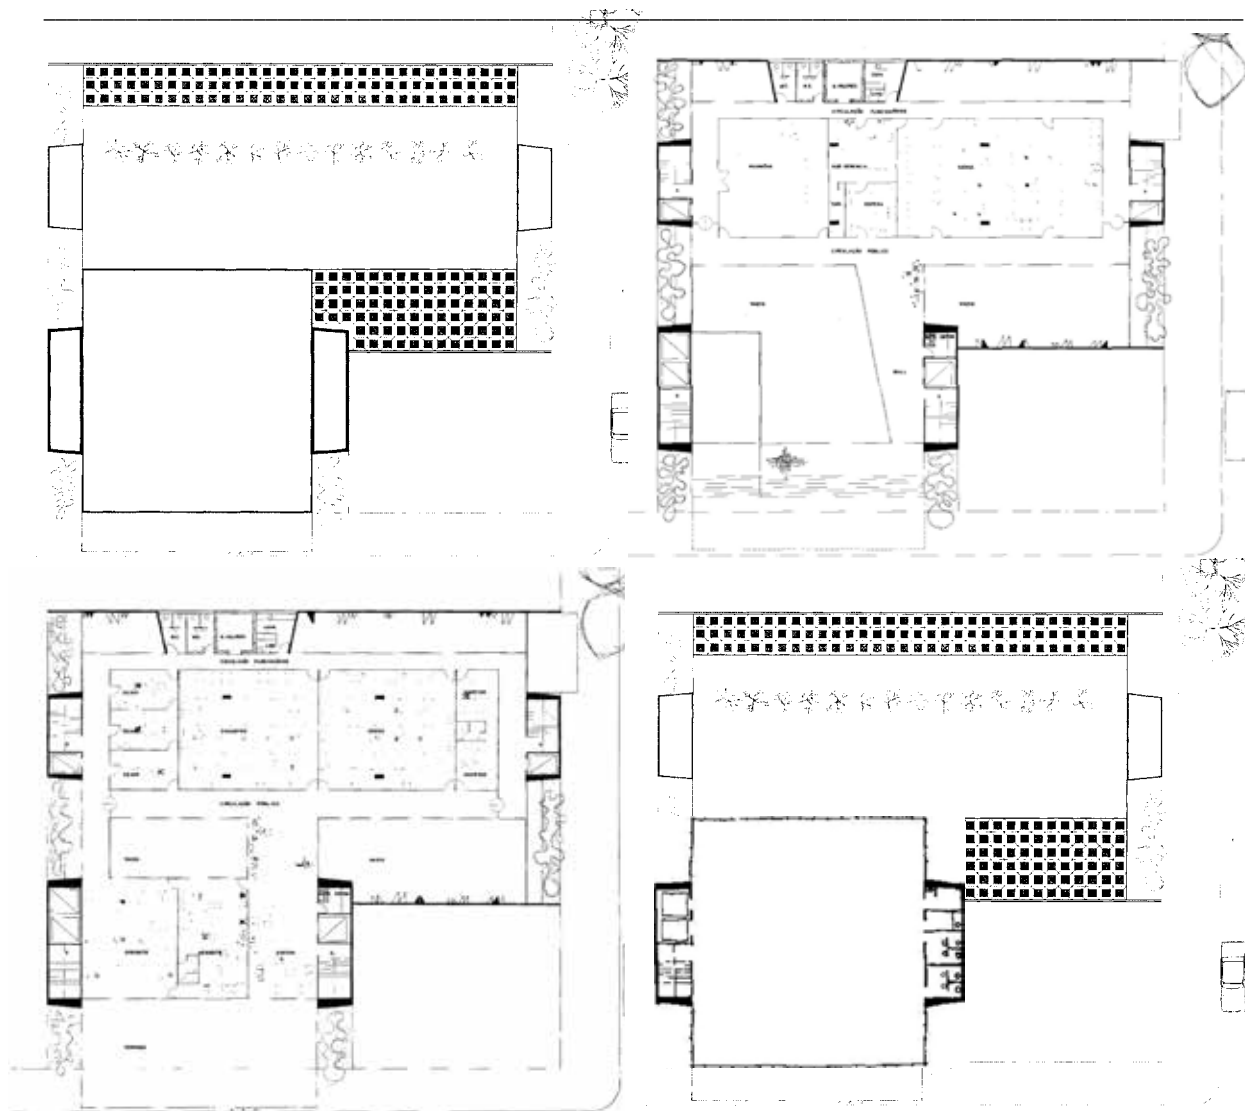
1º lugar (L. Forte Netto, José M. Gandolfi, Roberto Gandolfi, J. Ramalho Jr. e Vicente de Castro; planta de cobertura;
